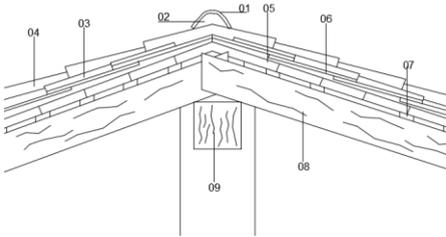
Detalle constructivo cubierta inclinada. Fuente: Propia de la autora
